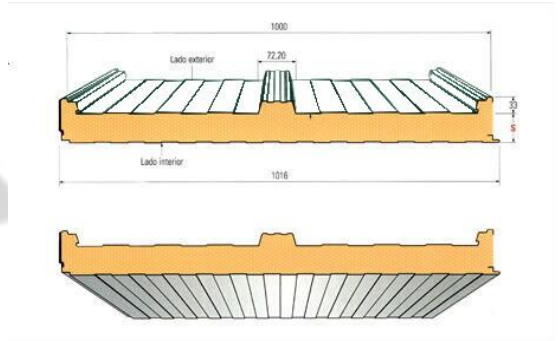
Panel Sándwich perfil. Fuente: panelsandwich.com
